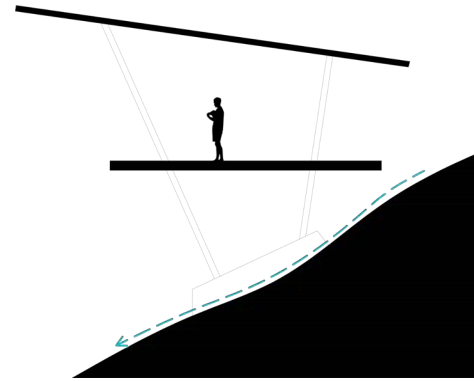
, Elevar Estructura, Guillén Rivera, A. (2021)
